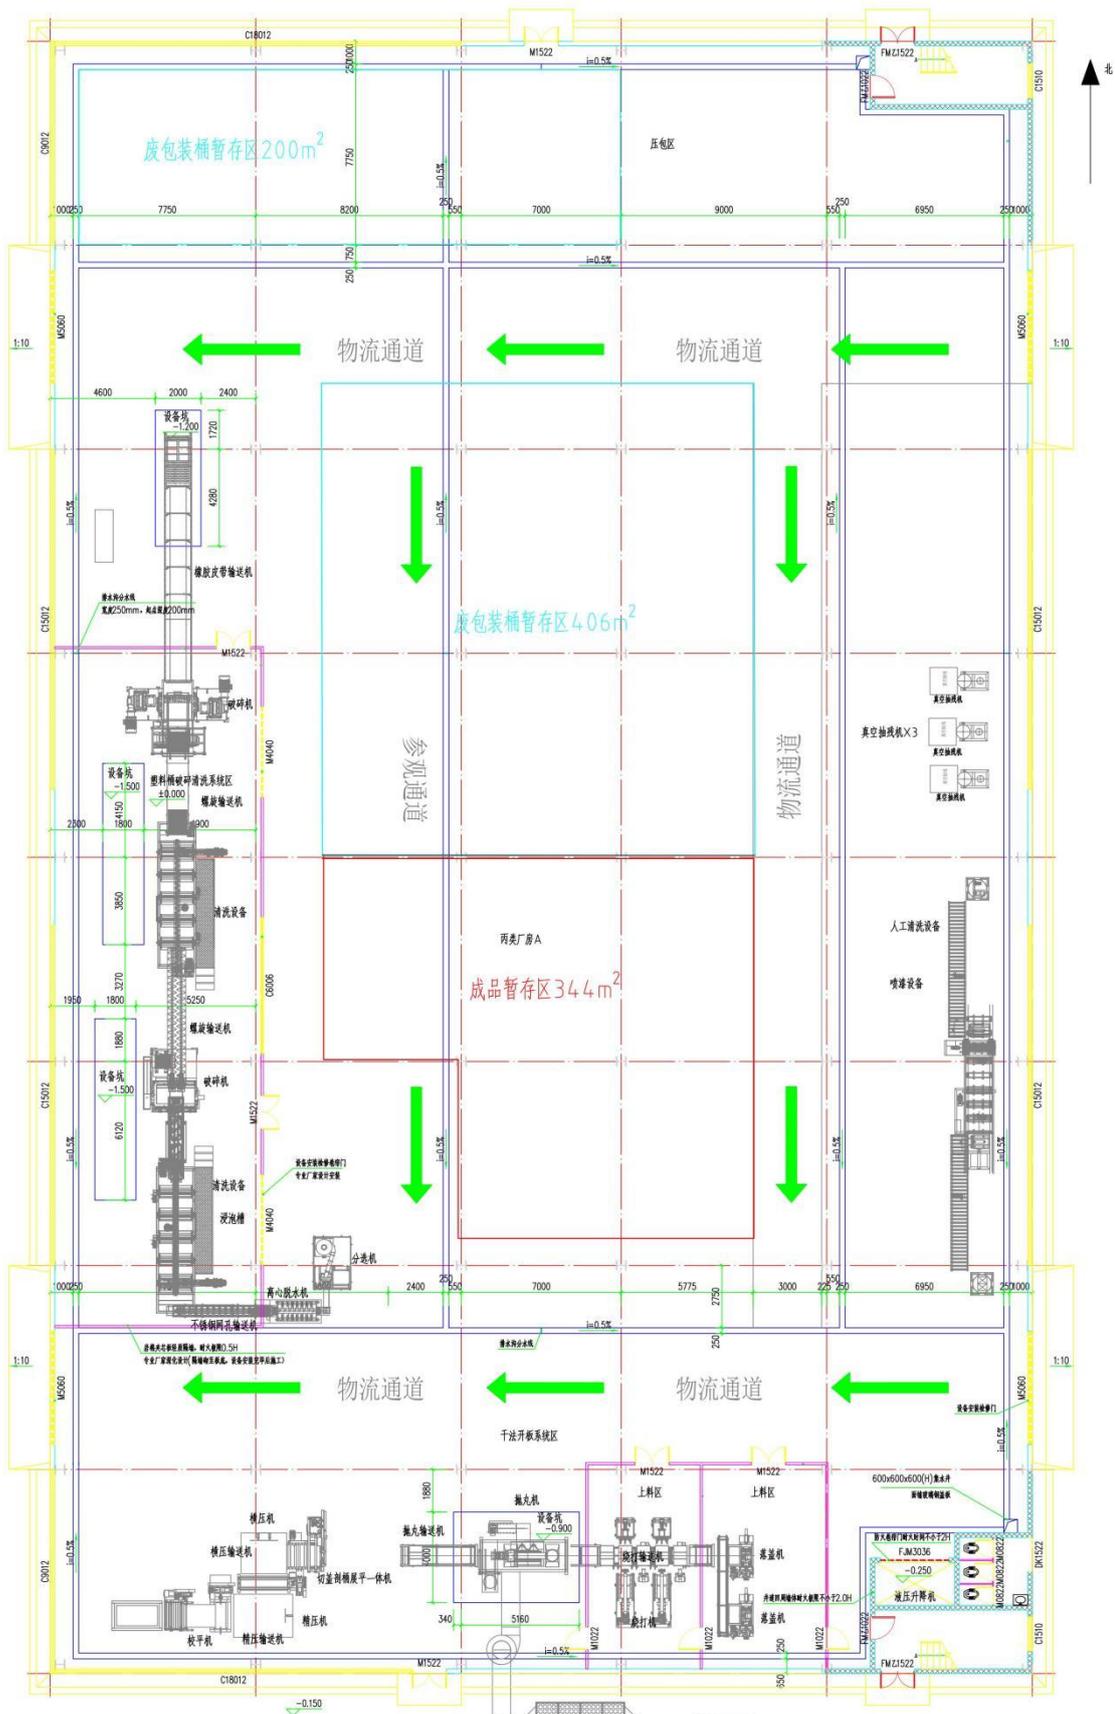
项目丙类厂房 A（洗桶）车间平面布置图
